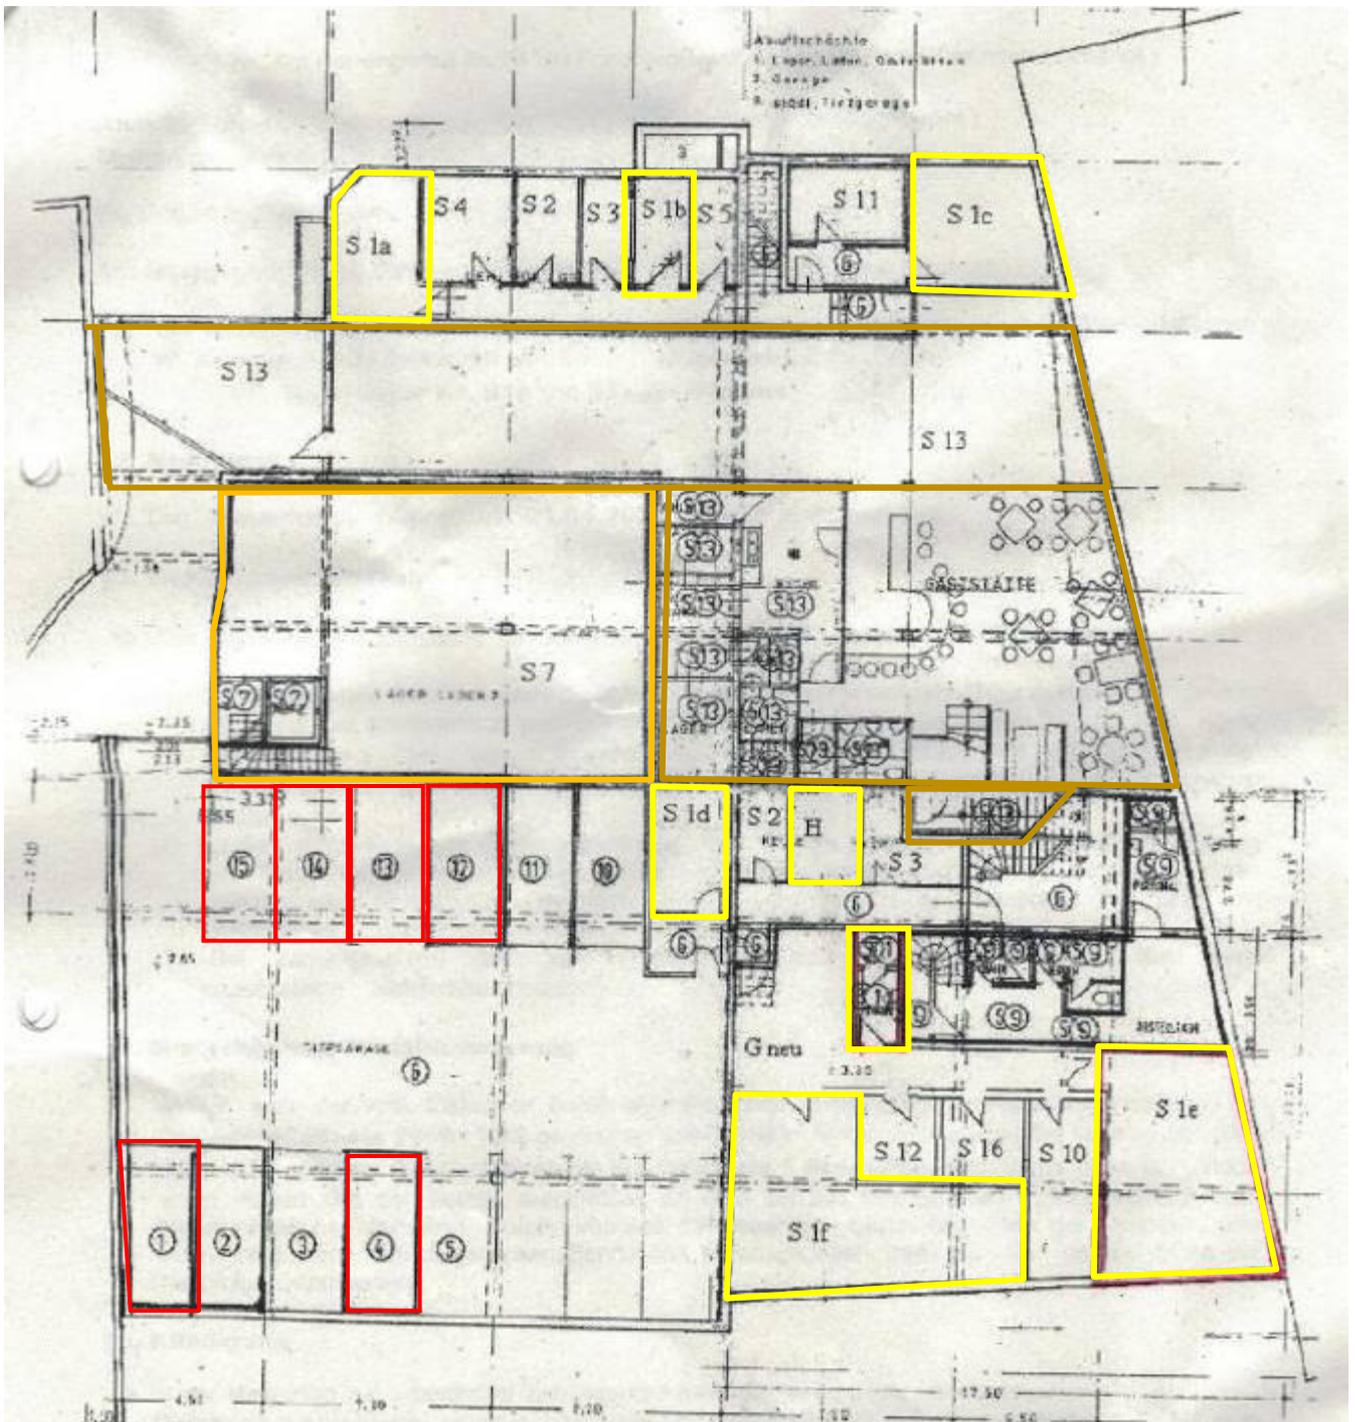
Grundrissplan Untergeschoss (ohne Maßstab); Detail: Gewerbeeinheiten S1a-g+ H (gelb), S7 (orange), S13 (hellbraun) und 6 PKW-Stellplätze (rot); Quelle: Objektunterlagen der Hausverwaltung; Farbeintragungen durch den SV
